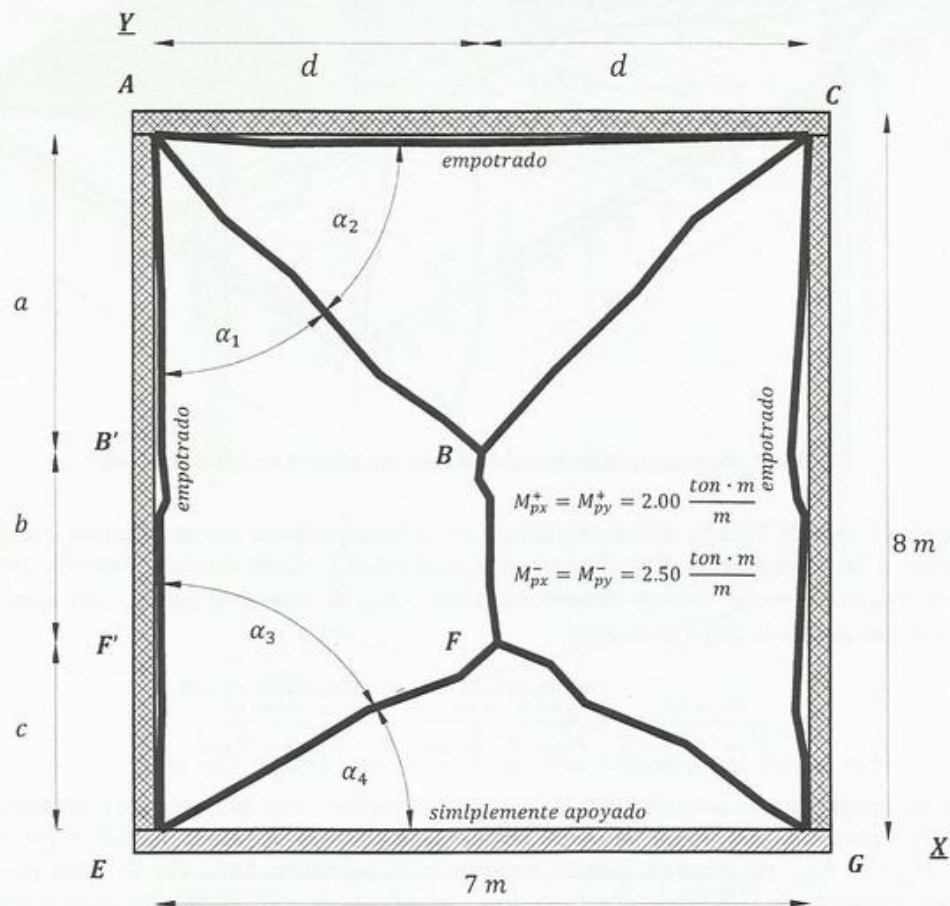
Mecanismo de colapso posible de una losa con refuerzo en dos direcciones. Ejemplo 16.7
